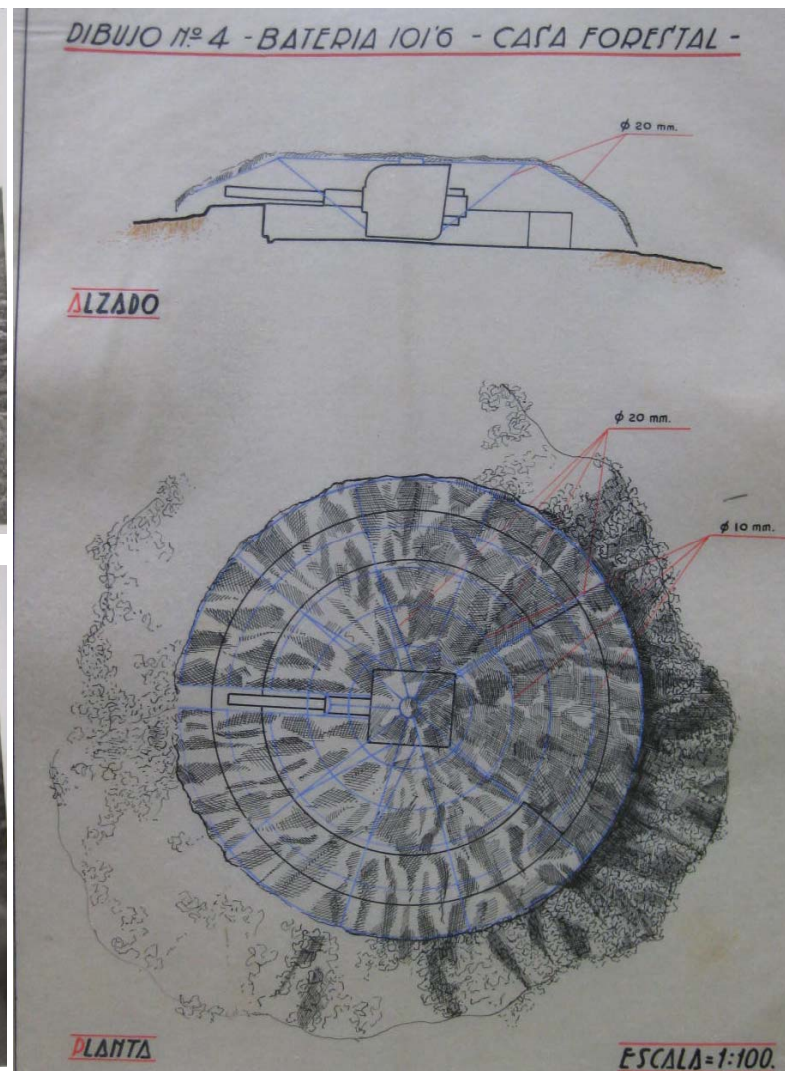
Planta y sección del proyecto de enmascaramiento.
